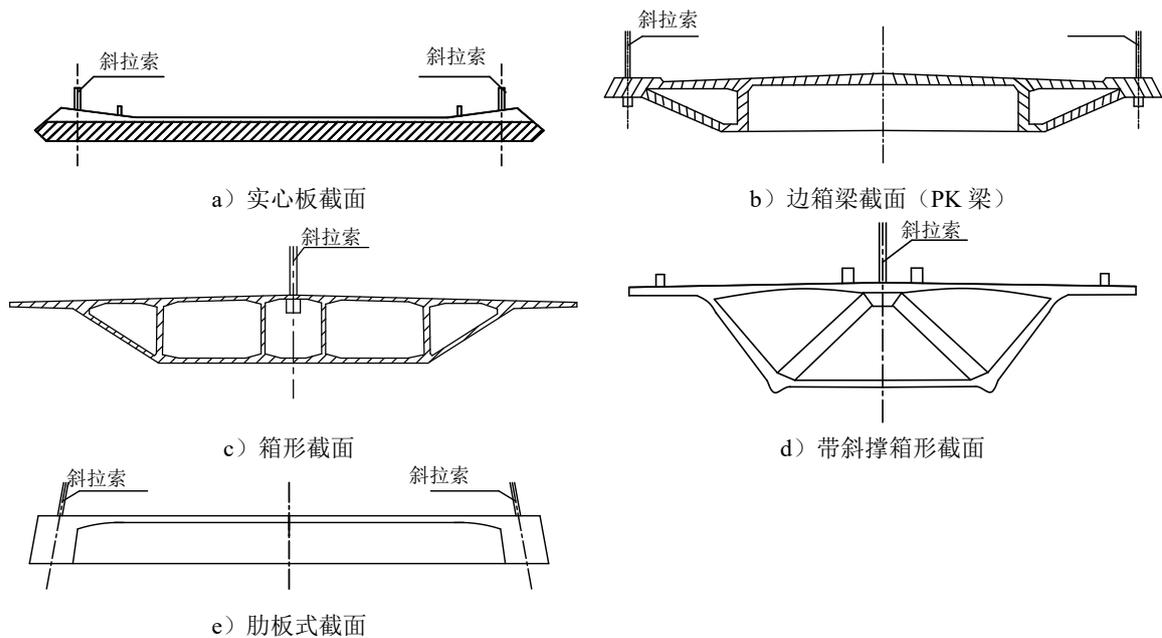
混凝土斜拉桥主梁典型截面示意
